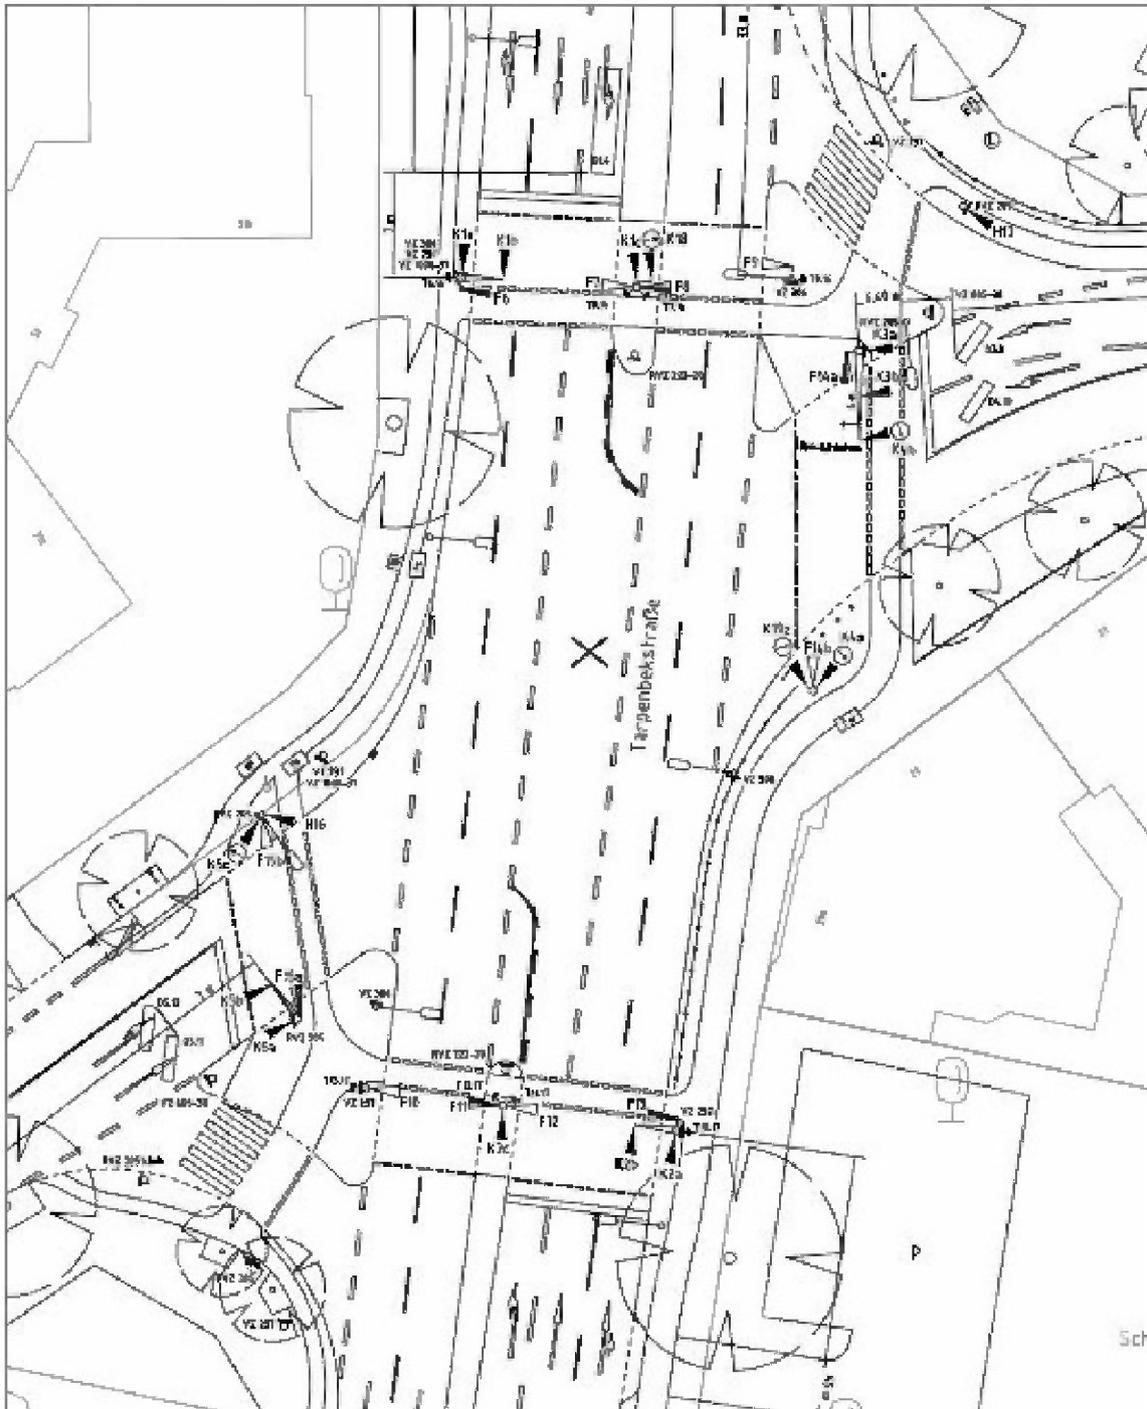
1 Signallageplan LSA 869 mit getrennter Zufahrtssignalisierung Martinstr.
